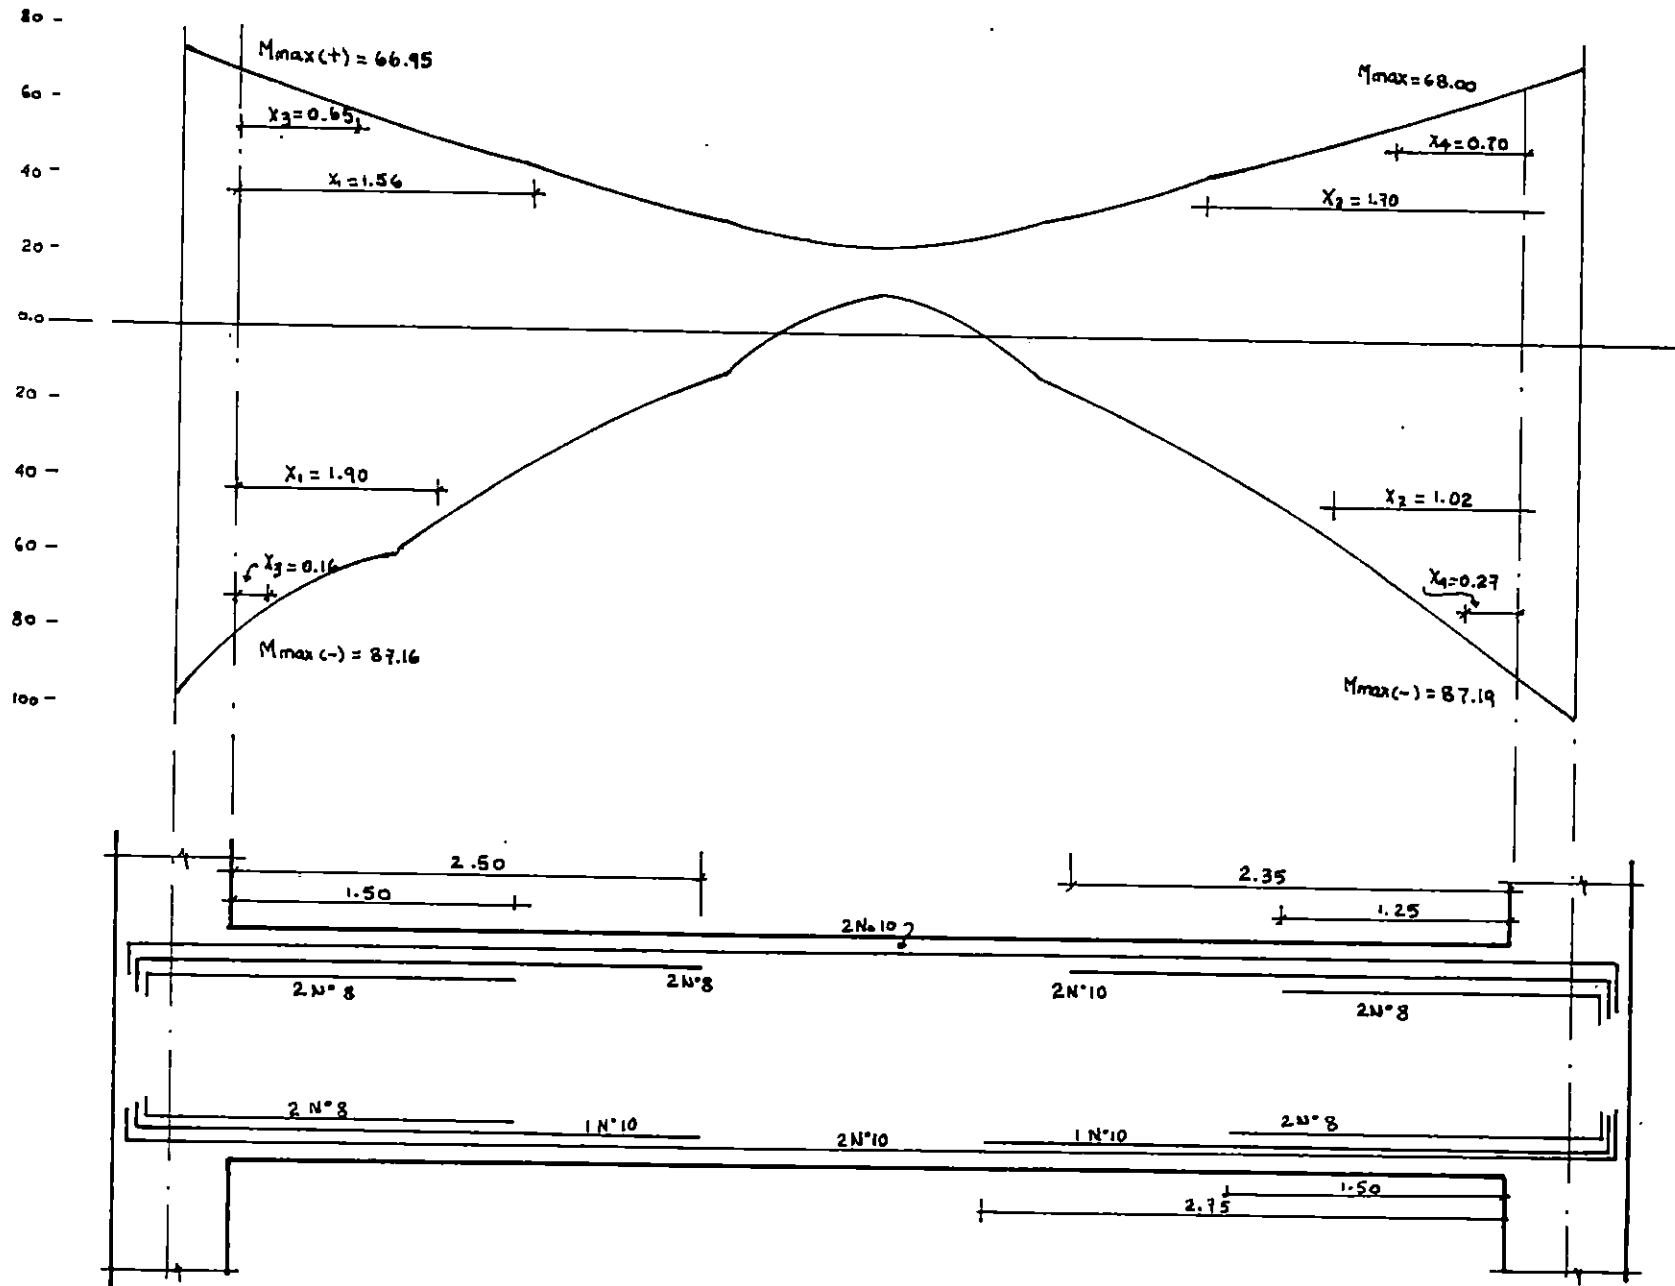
ENVOLVENTE Y DETALLE DEL REFUERZO LONGITUDINAL
